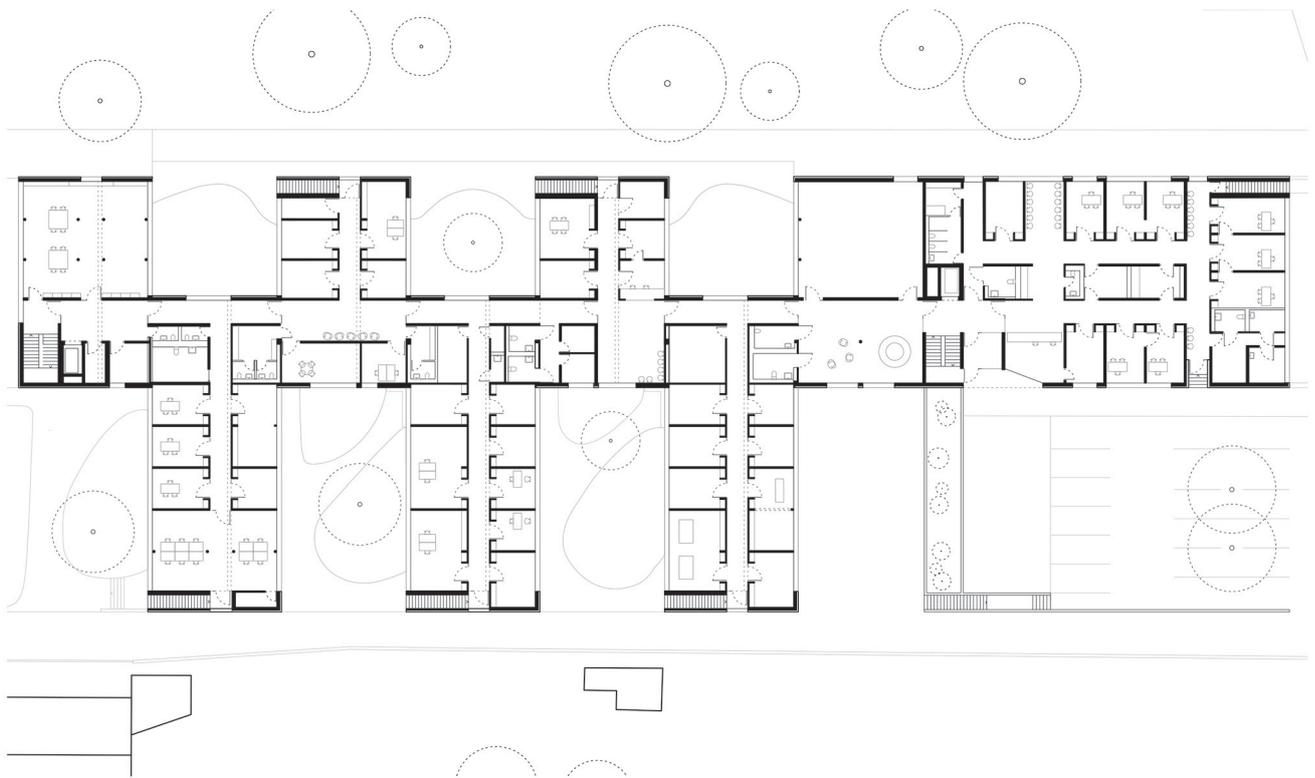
Grundriss Eingang Medizinisches Versorgungszentrum
